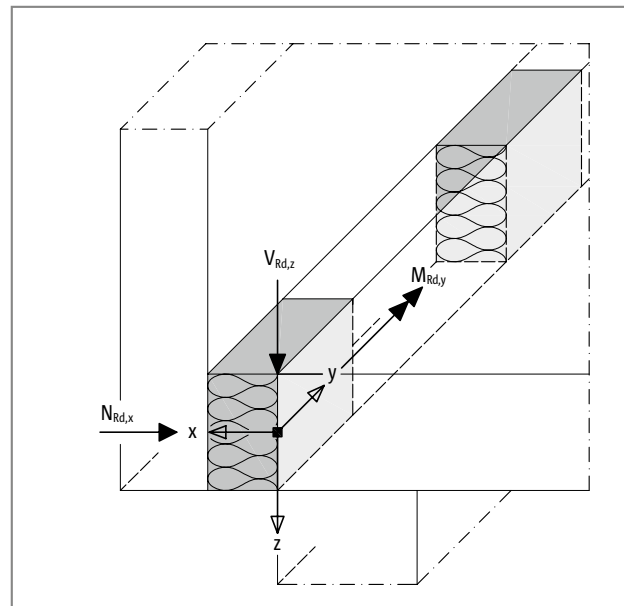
Schöck Isokorb® XT tipo AP: regola dei segni per il calcolo dei parapetti anteposti
